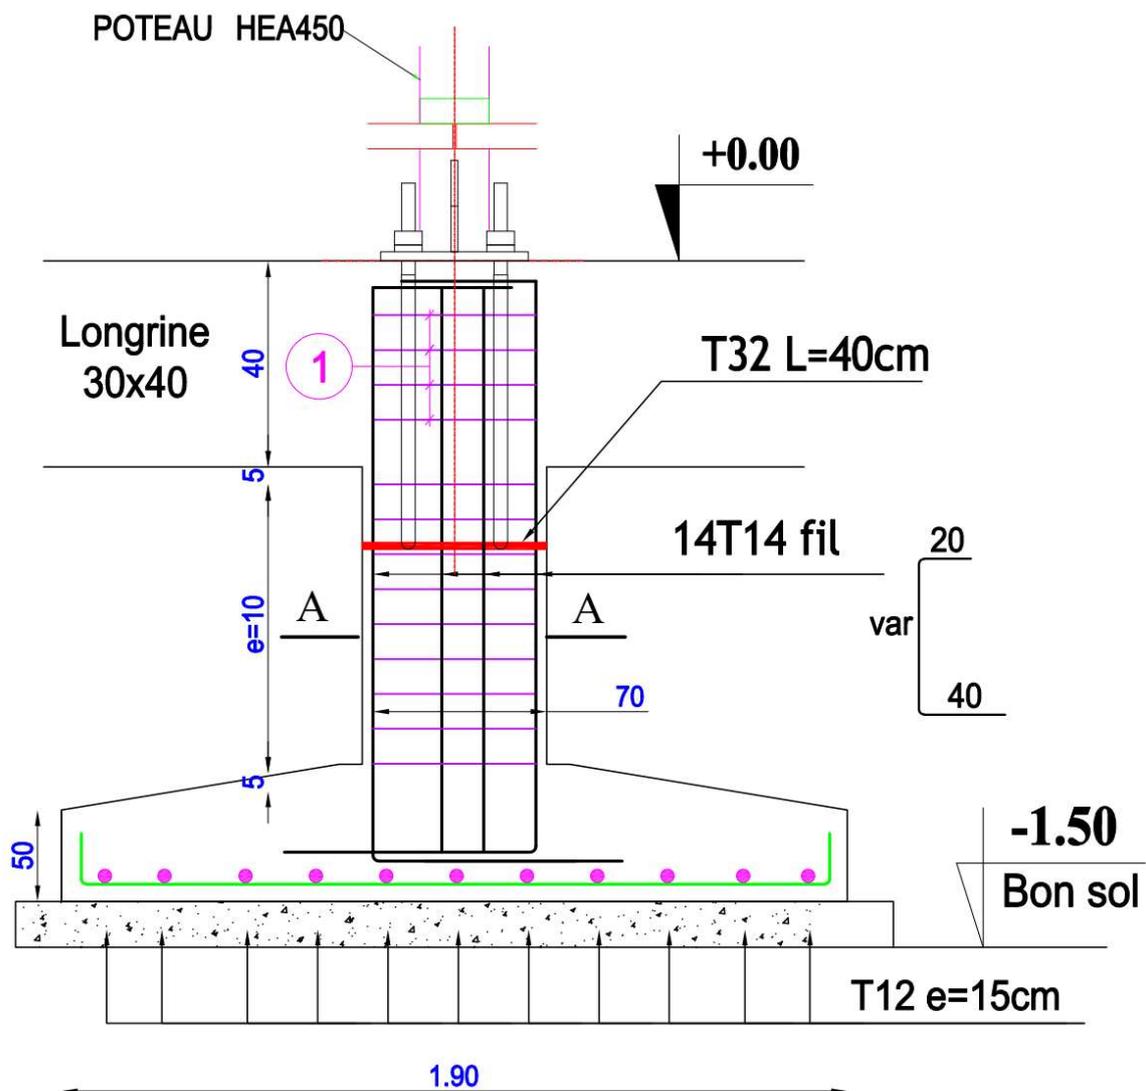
Plan de ferrailage avant poteau avec tige d'encrage ech : 1/25
